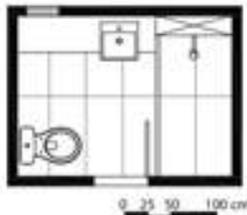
Sugestão "B" de planta baixa do banheiro nº 3.
